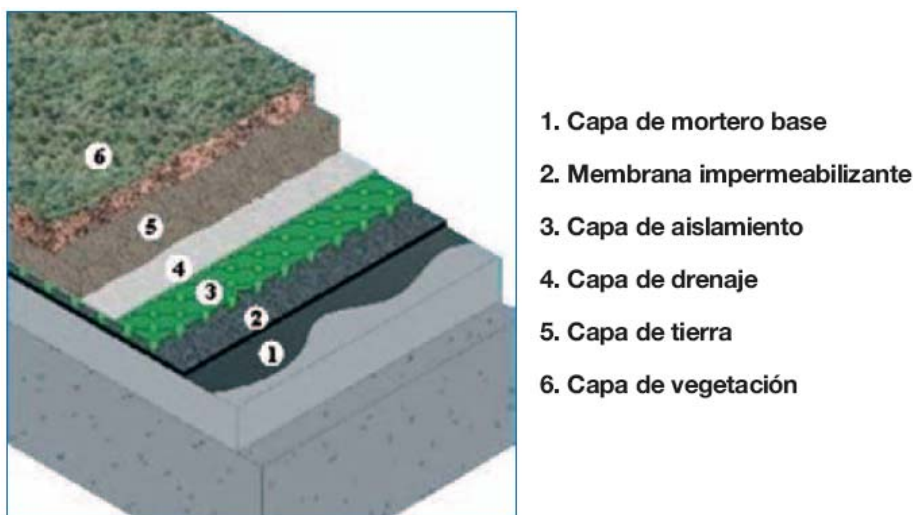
Detalle de cubierta ajardinada. (Elaboración: propia)
